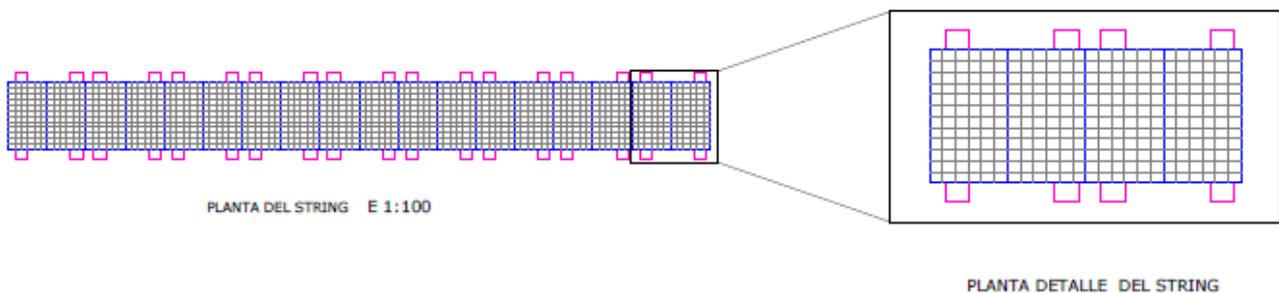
Detalles de la cimentación strings. Fuente: elaboración propia.
